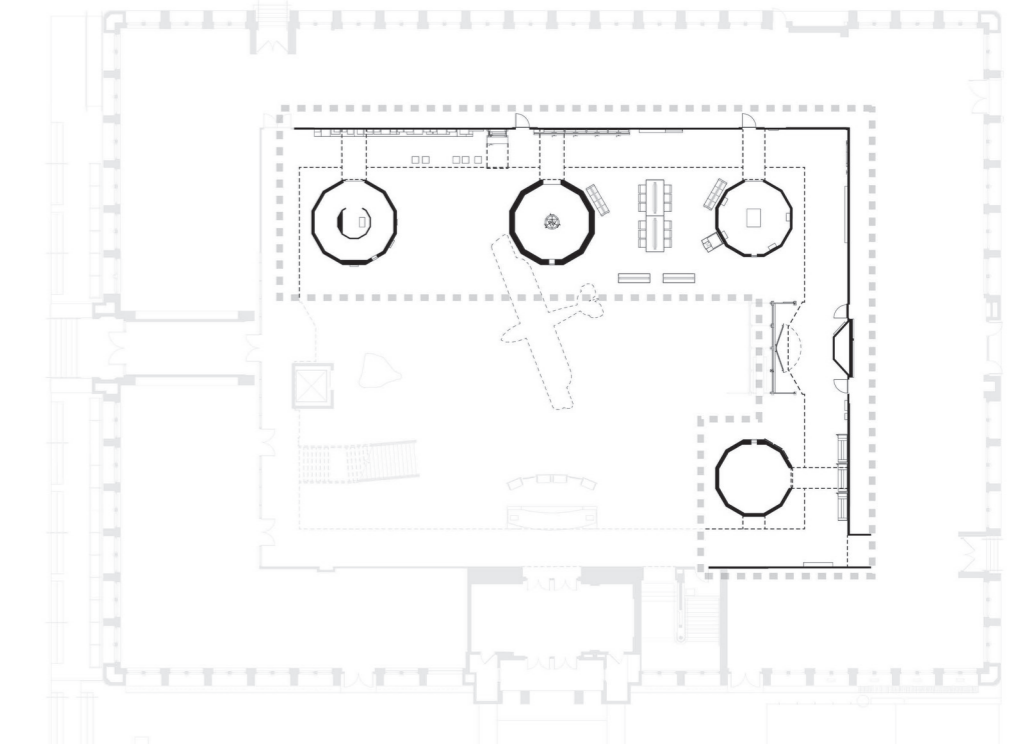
Planta arquitectónica del Bezos Center for Innovation
